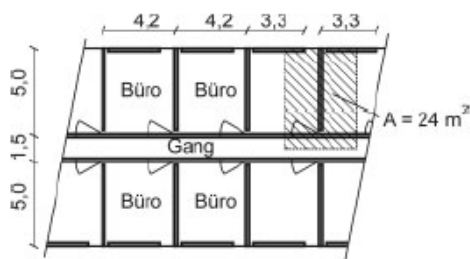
Grundriss von Tragwerkstyp I [7]
